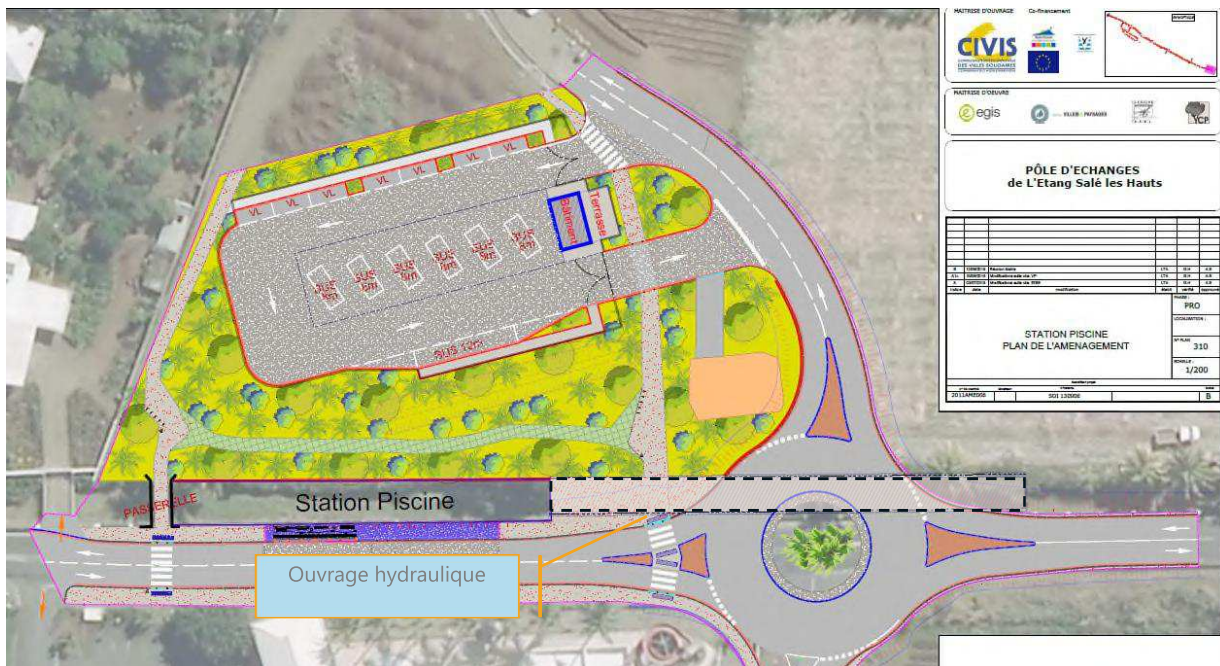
Position de l'ouvrage de franchissement de la ravine Deschenez (Source : Egis)
